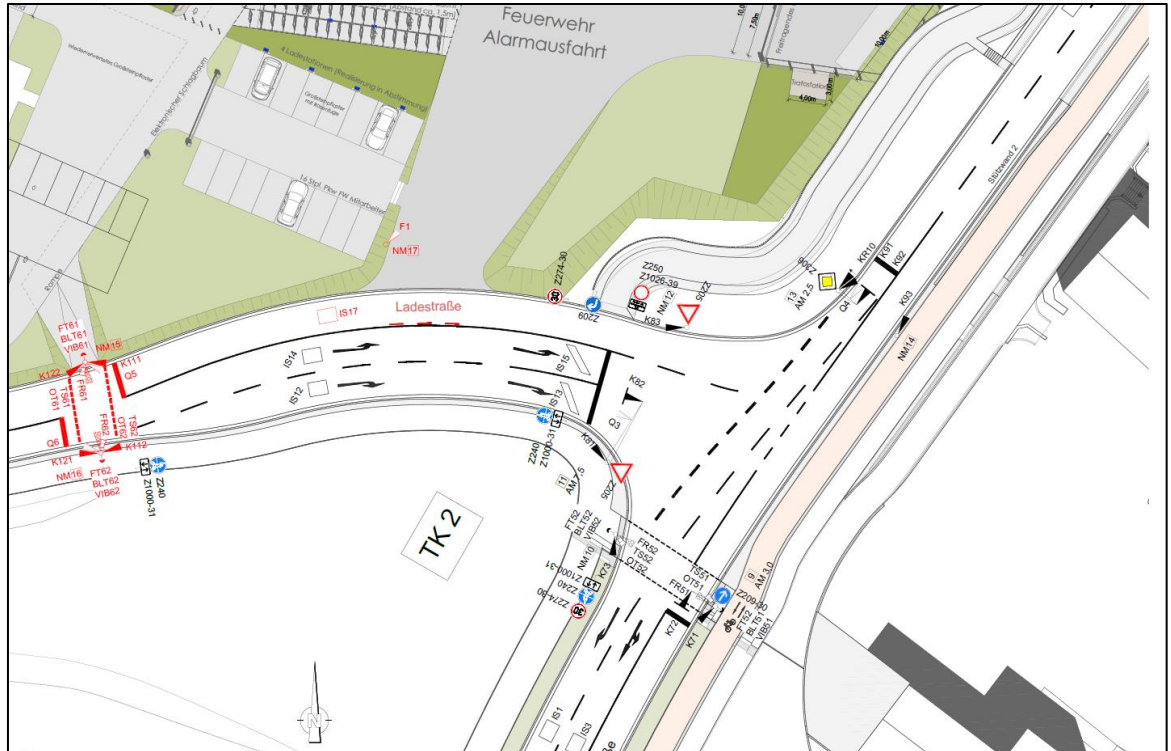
Lageplan FLSA Ladestraße und LSA Ladestr./ Poeler Str./ Bahnhofstr./ Poeler Tor (TK Nord)
